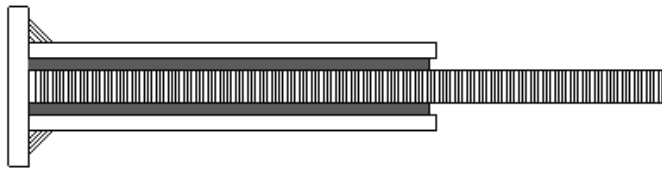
Anclaje tipo con pieza soldada y resina.
